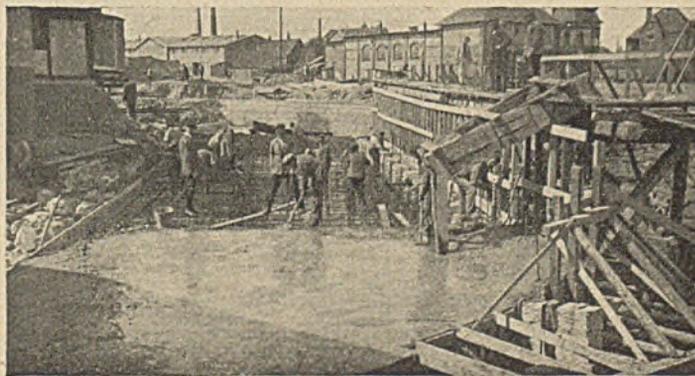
Betonierung einer Kaimauerstrecke vom Schüttgerüst aus.
